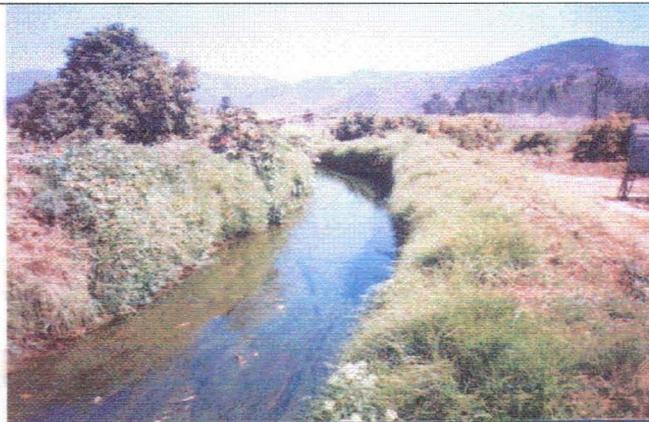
Sección. Tramo del canal con baja pendiente y enmalezamiento generalizado.
